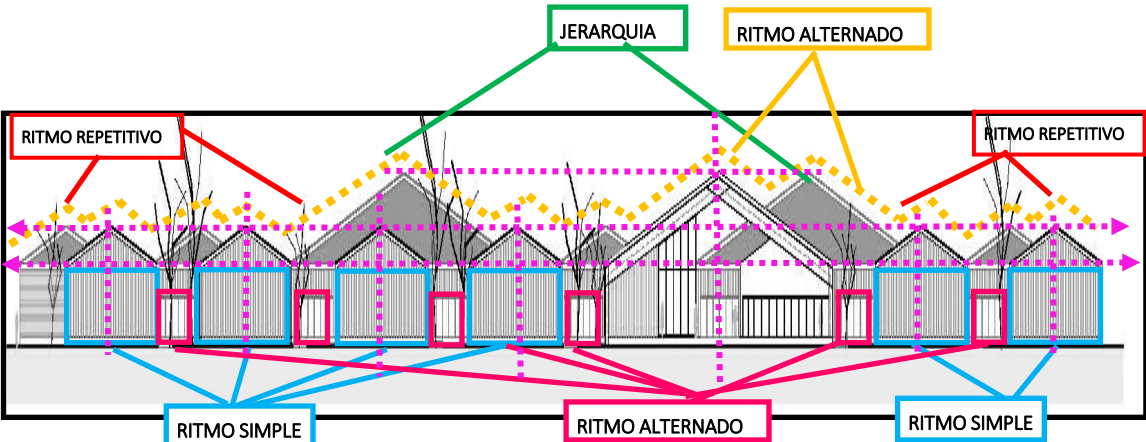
ALZADO DE FACHADA PRINCIPAL-HOSPITAL PUYO
